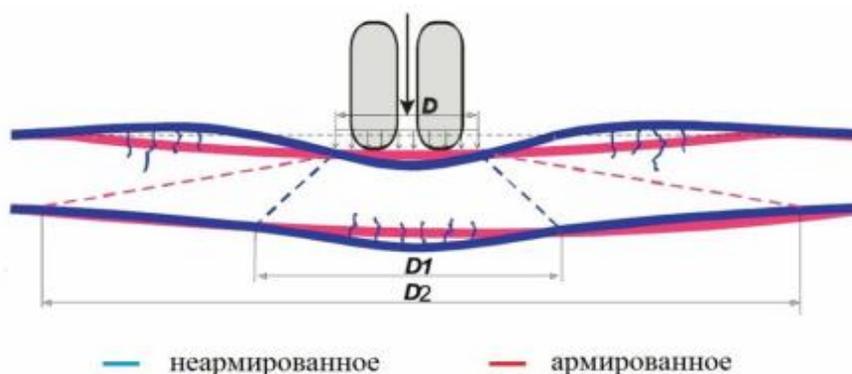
Асфальтобетонное покрытие под колесной нагрузкой
